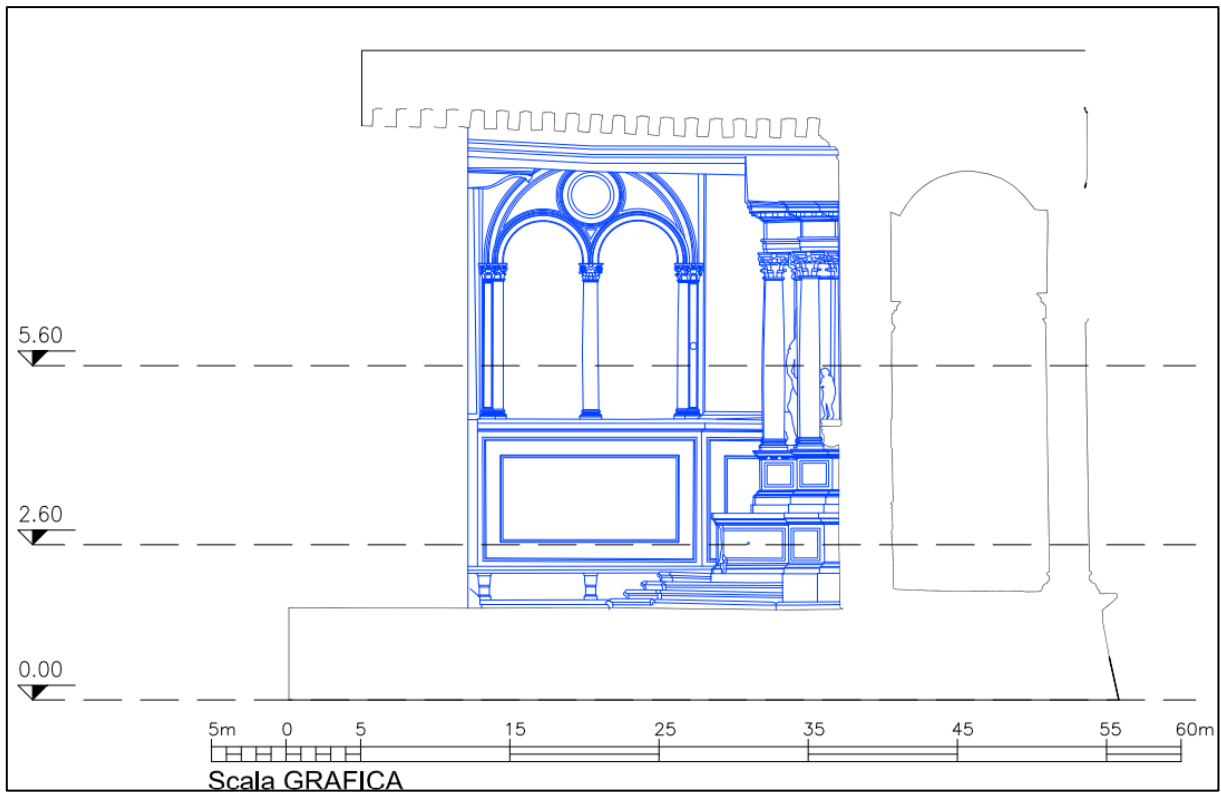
Sezione 4.2 – Sezione verticale e vista prospettica
